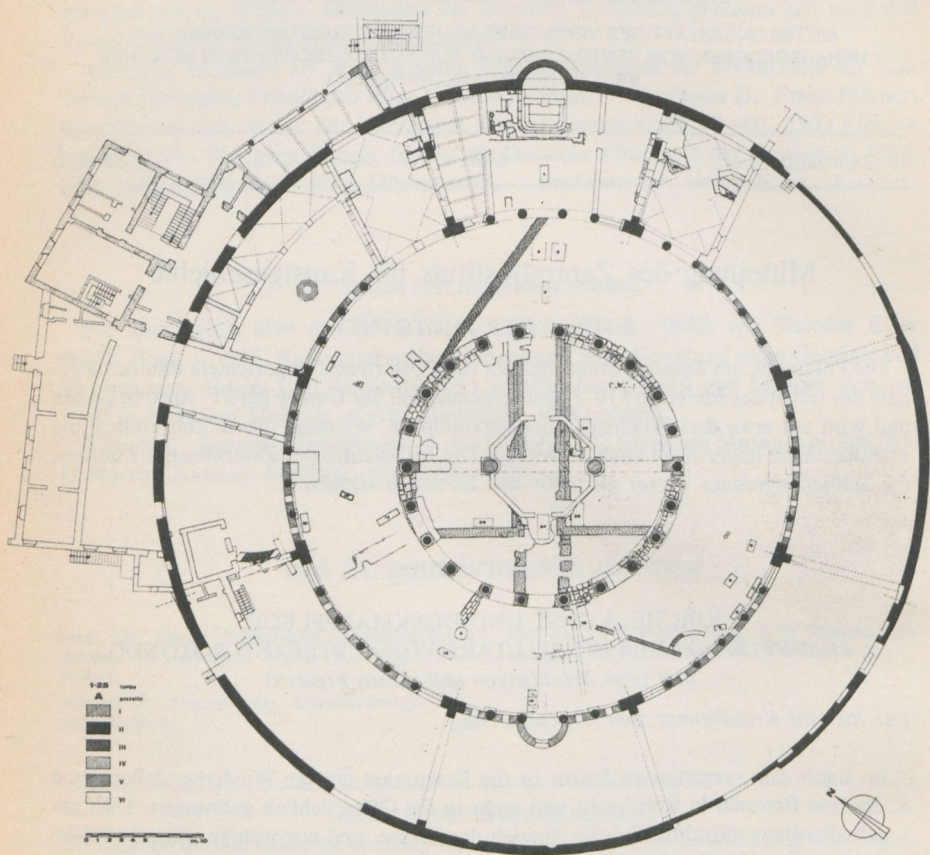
Rom, S. Stefano Rotondo, Grundriß mit dem Ausgrabungsbefund (nach C. Ceschi)
